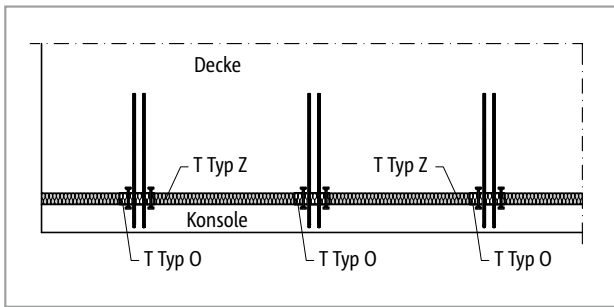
Schöck Isokorb® T Typ O, Z: Konsole
